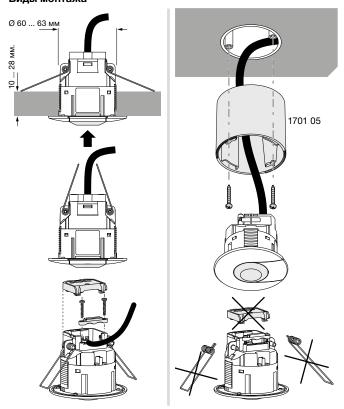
Монтаж в подвесной потолок / в коробку для наружного монтажа 1701 05
